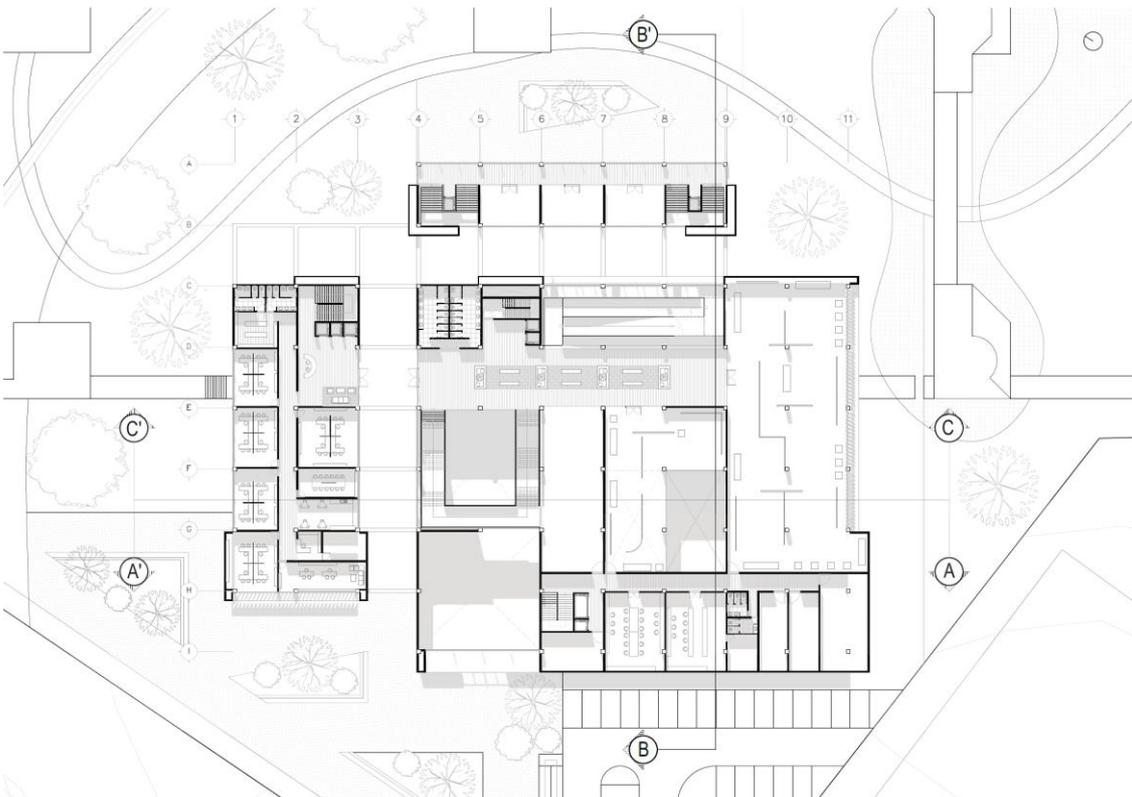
Planta – Nivel + 5.00. Elaboración propia.
